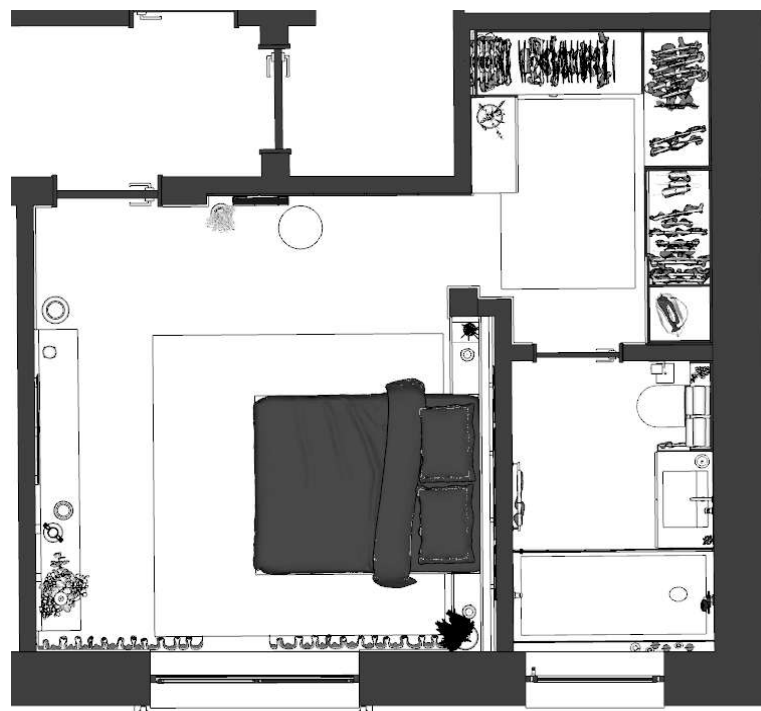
Planta s/escala, Suite. Fonte: Autora.
